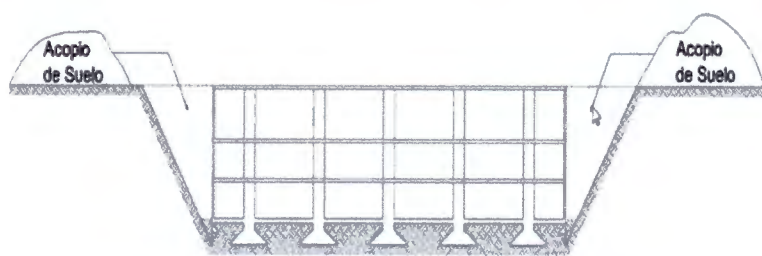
Estructura hasta planta baja en condiciones ideales
